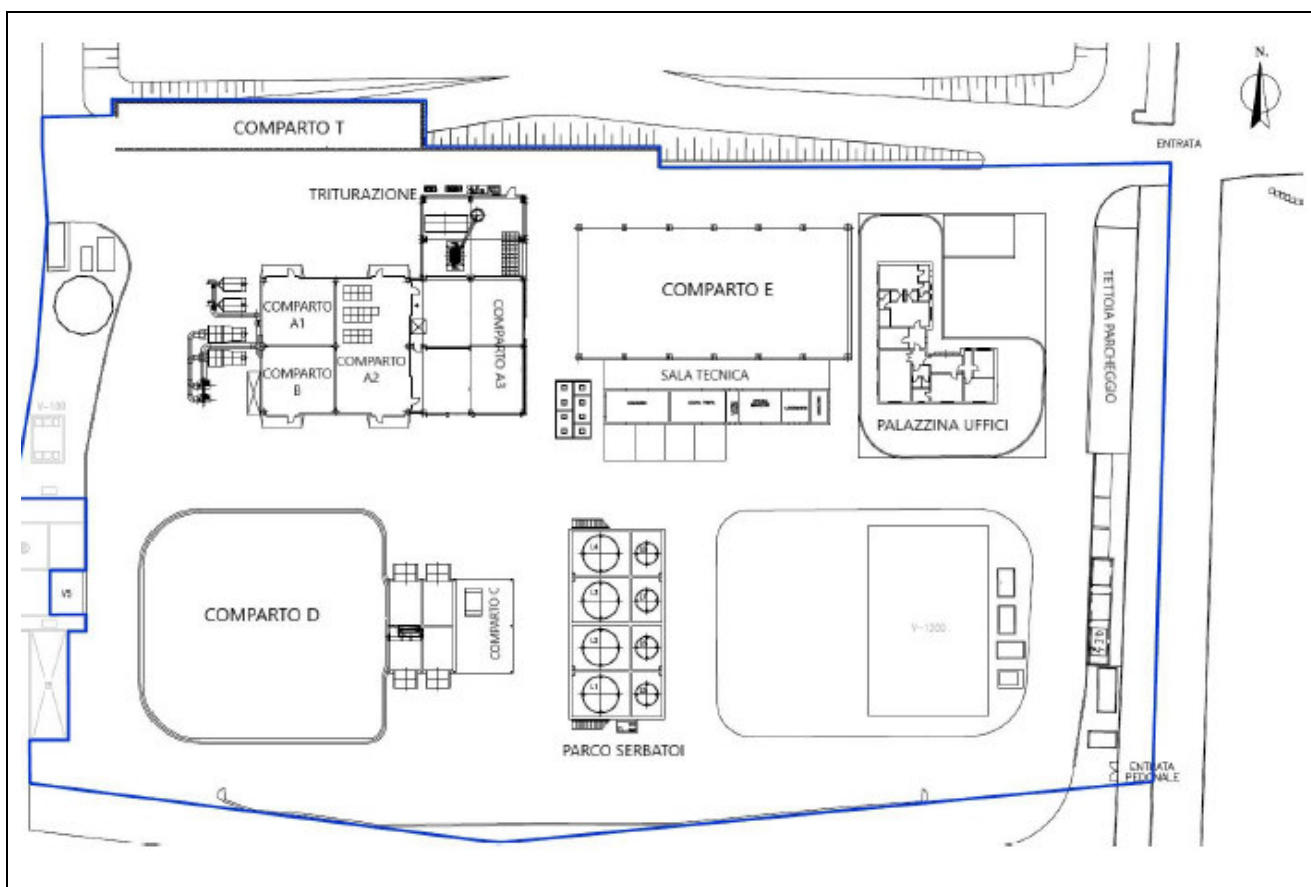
Planimetria del Centro di Stoccaggio e Pretrattamento rifiuti
